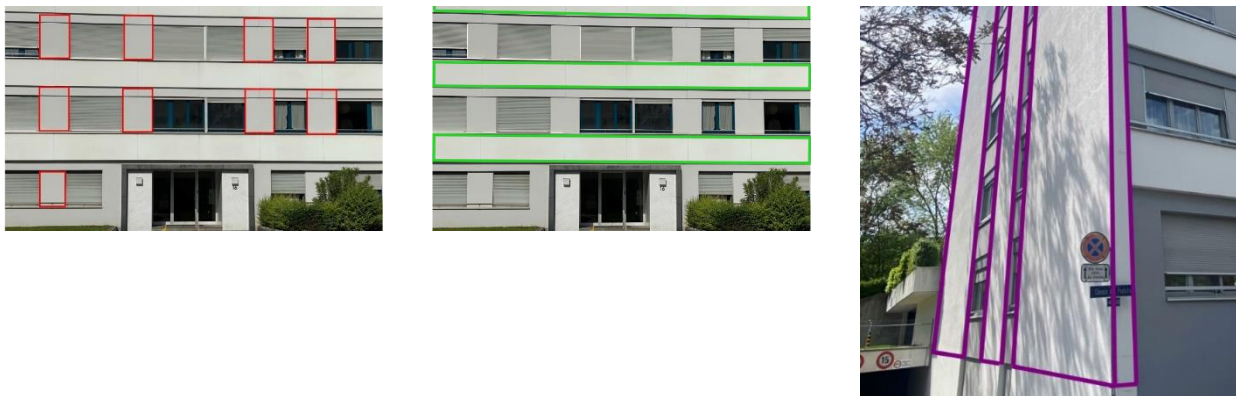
Eléments de façade (gauche : « Façade 22 » - meneaux situés entre les fenêtres, milieu : « Façade 32 » - allèges maçonnées situé sous l'ensemble, droite : « Façade 39 » - façades pignons). Source : Hachemi, 2021.
